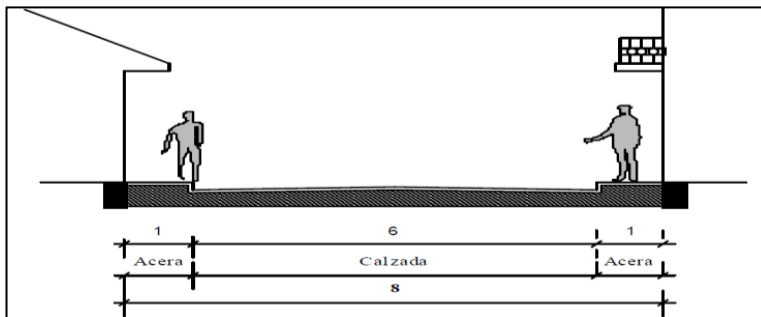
VÍAS LOCALES - SECCIÓN VIAL MÍNIMA
